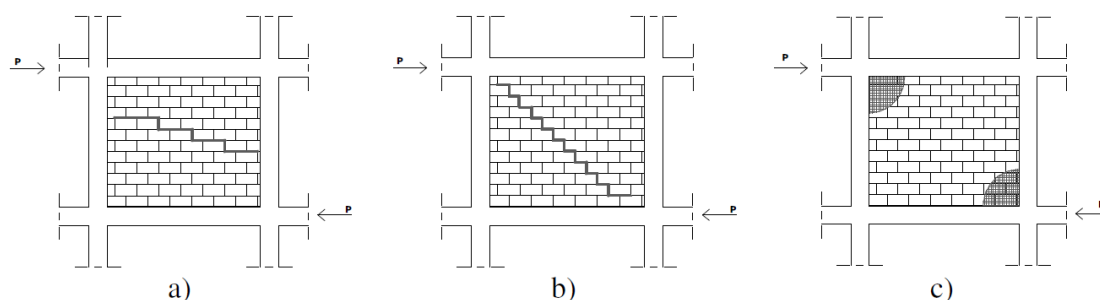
Mecanismos de rotura da alvenaria (adaptado de [17]).
